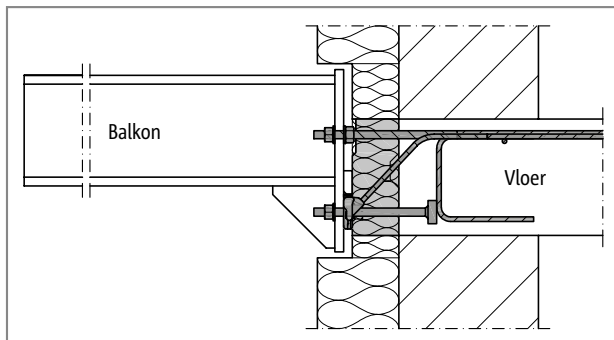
Schöck Isokorf® T type SK: vrij uitkragend balkon
